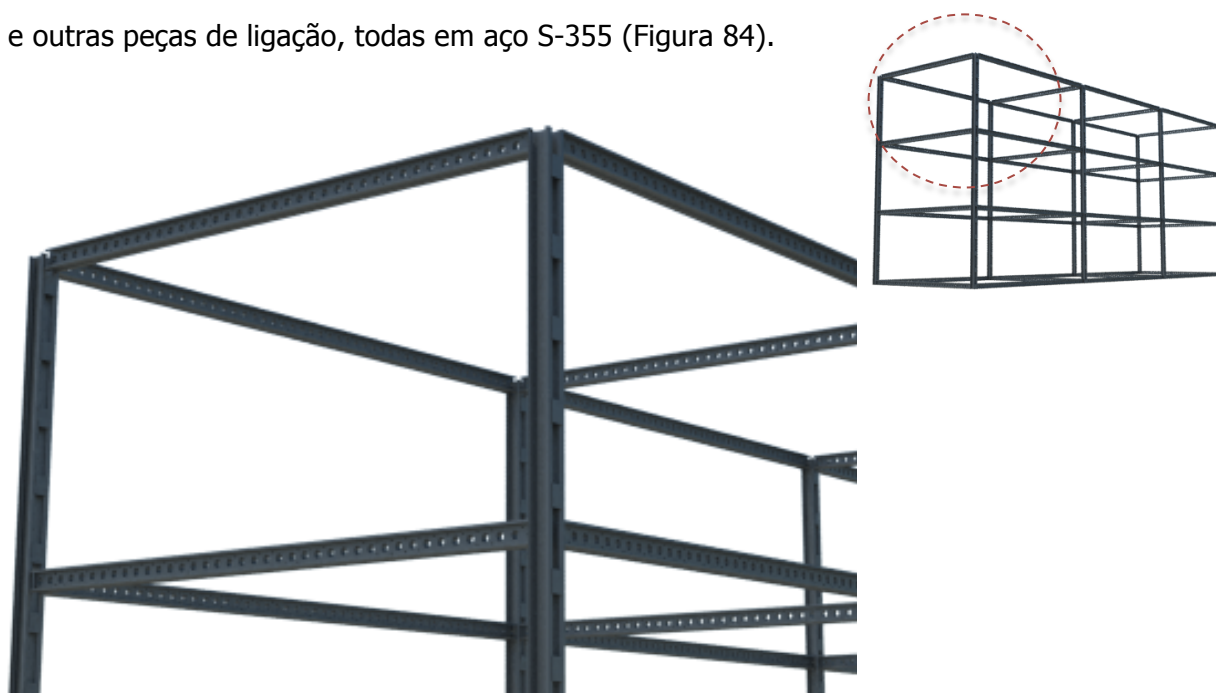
Estrutura metálica em sistema RMD na zona norte do Capitólio para suporte dos Ateliers, utilizando elementos *MegaShor* na vertical e elementos *SuperSlim* na horizontal (24,50 x 6,80 x 10,25m)
